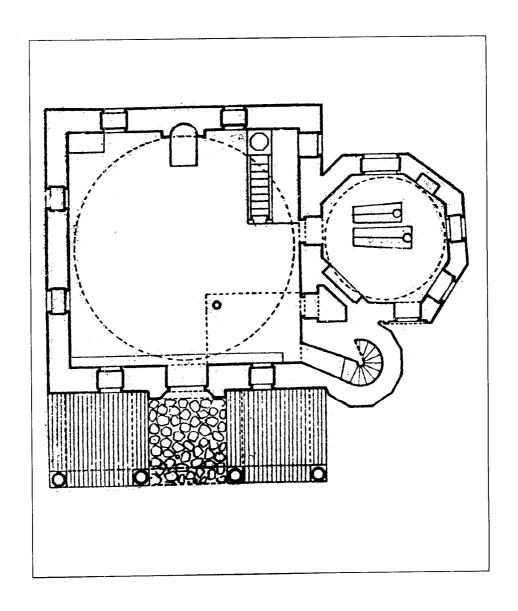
مسقط أفقي لمسجد نيش هومسجد قراكوز محمد باشا في موستار ه (عن :Pašić) .
